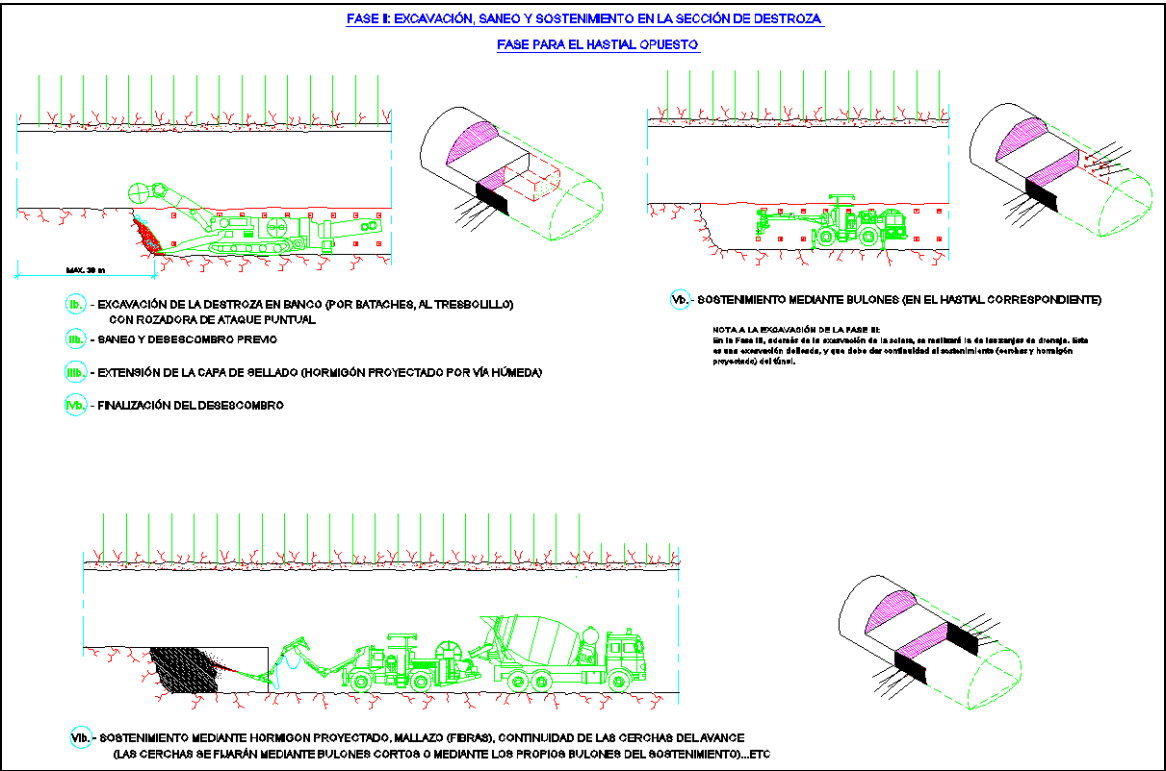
Fase de excavación en la sección de Destroza, hastial opuesto.
